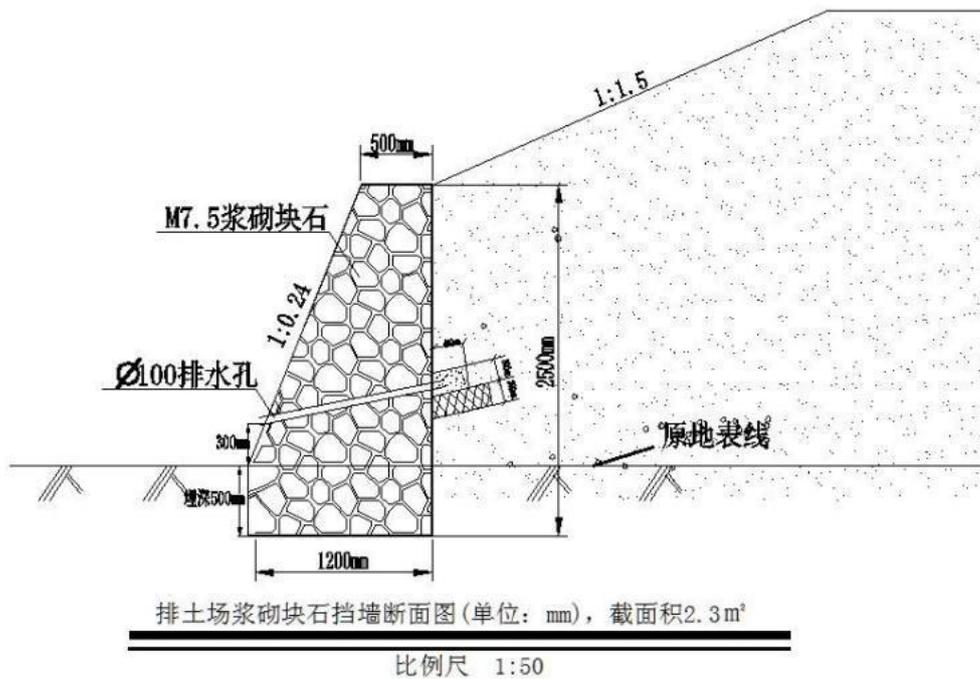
排土场浆砌石挡墙断面图（单位：mm）
